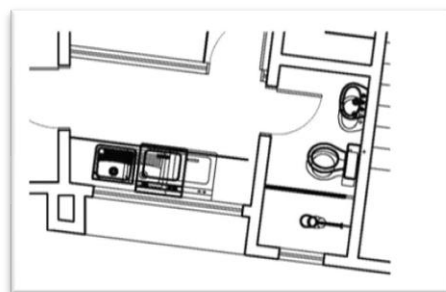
Planta baixa detalhe desalinhamento dos aparelhos.
